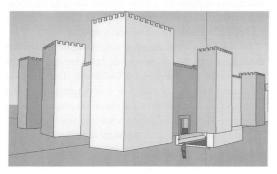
Reconstrucción de las fachadas sur y este, bajo la rasante el aljibe (Croquis del autor)
